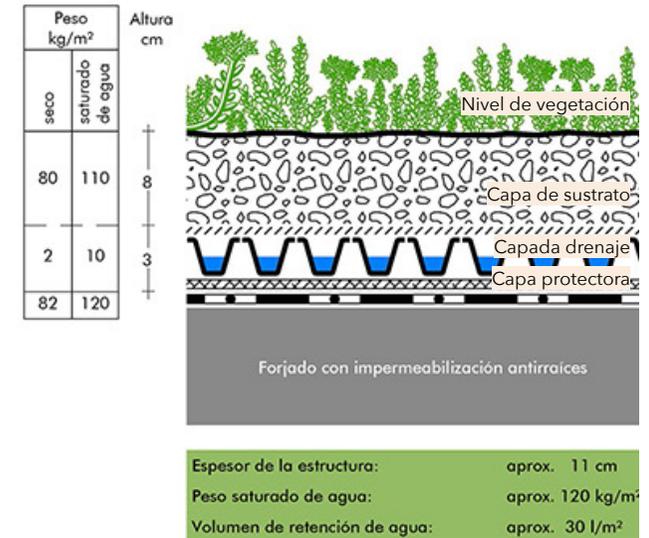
Grafica de funcionamiento sist. Extensivo Fuente: Guía de planificación. Cubiertas verdes 4.0, Zinco
